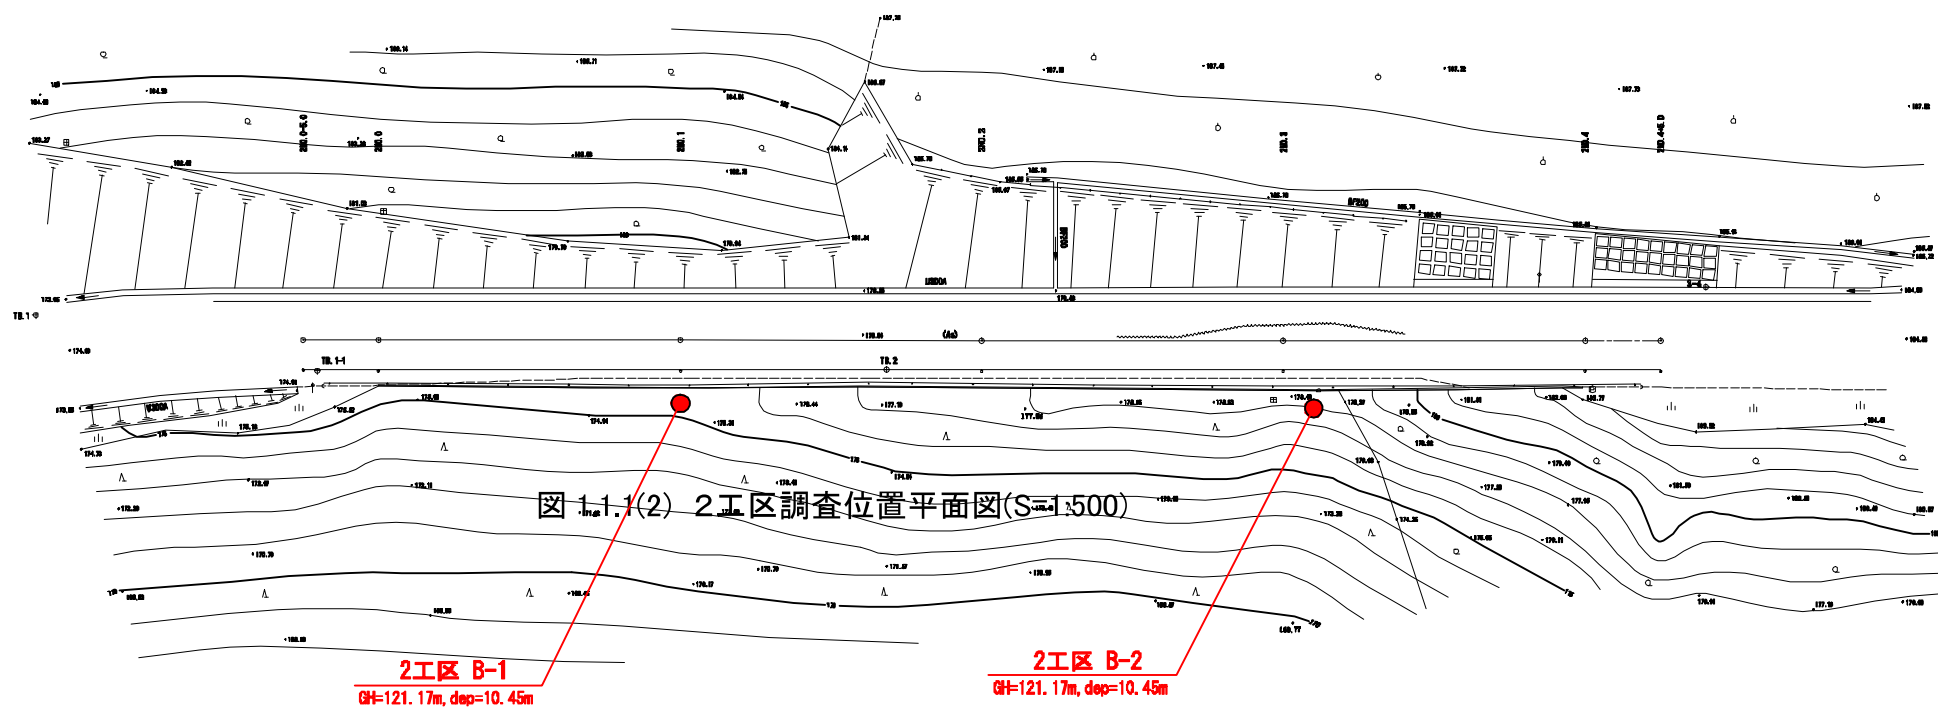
(2) 2工区調査位置平面図(S=1:500)
